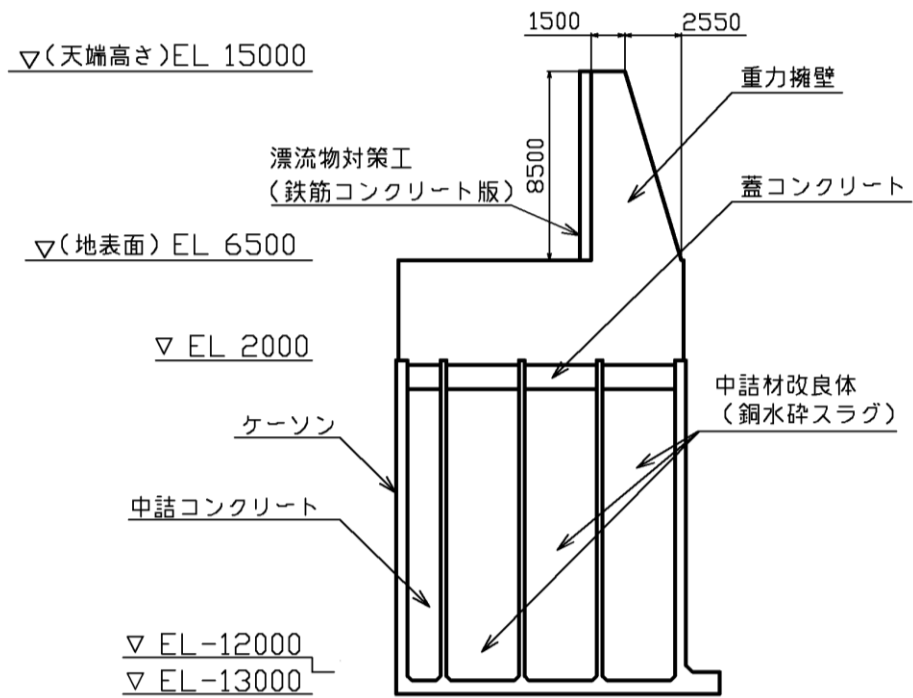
防波壁 (波返重力擁壁) の横断面図 (⑥-⑥断面)
